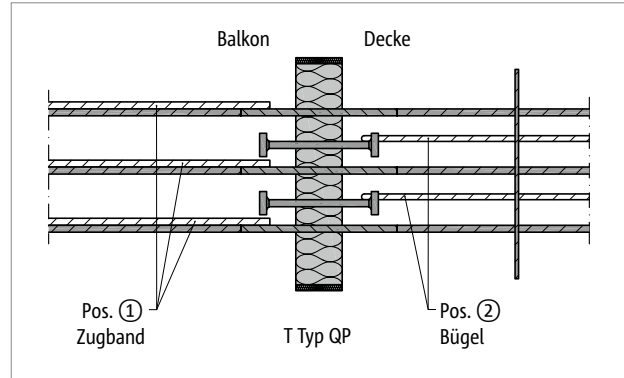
Schöck Isokorb® T Typ QP: Detail 1; Bewehrungsanschluss Zugband
